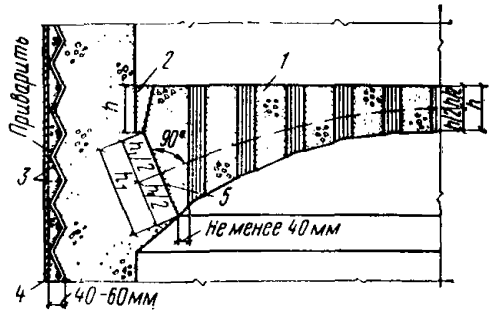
Конструкция купола перекрытия с технологическими отверстиями из жаростойкого бетона для круглого теплового агрегата
